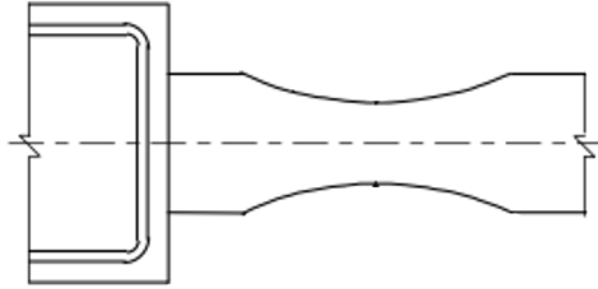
Corte de sección con vista en planta de la conexión viga/columna.
